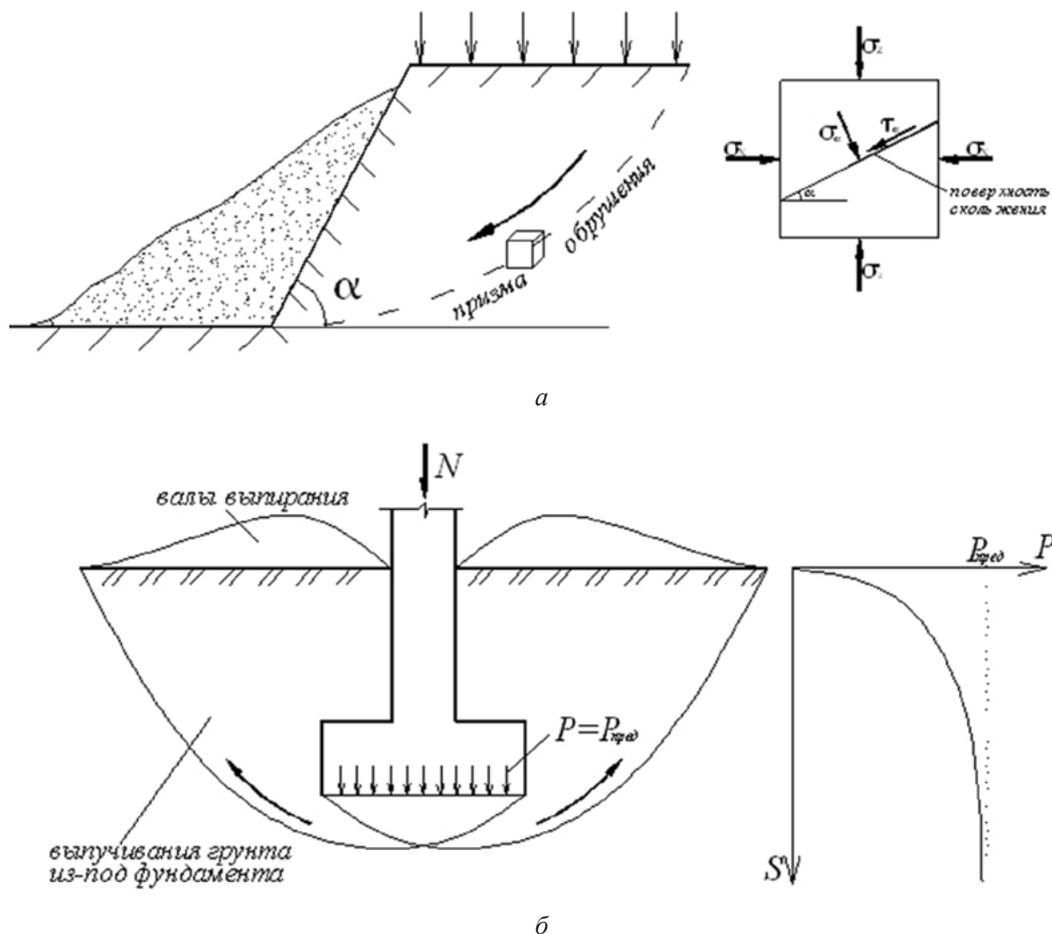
Схемы потери прочности грунта: а — обрушение откоса; б — выдавливание грунта из-под фундамента; $P = P_{пред}$ — предельная вертикальная нагрузка на фундамент; P — нагрузка на фундамент; S — осадка фундамента
